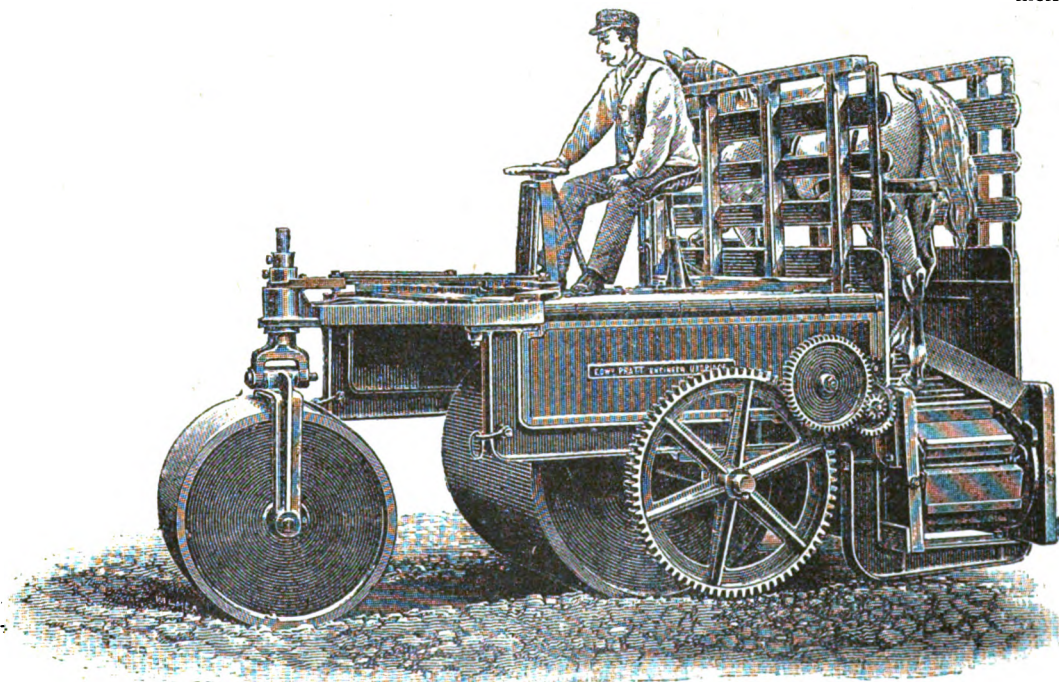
Strassenwalze mit Pferdebetrieb von E. Pratt, Uxbridge.
